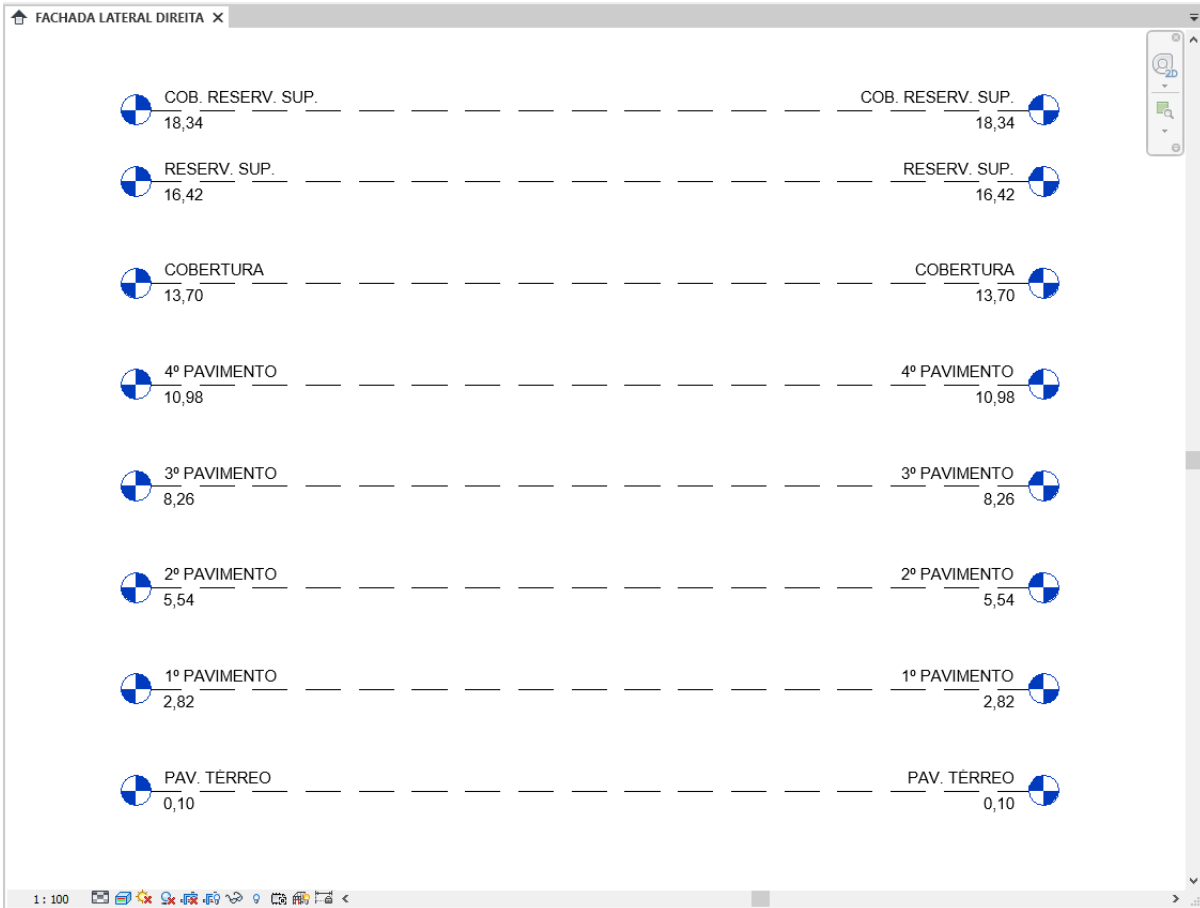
Níveis dos pavimentos através da vista da Fachada Lateral Direita.
